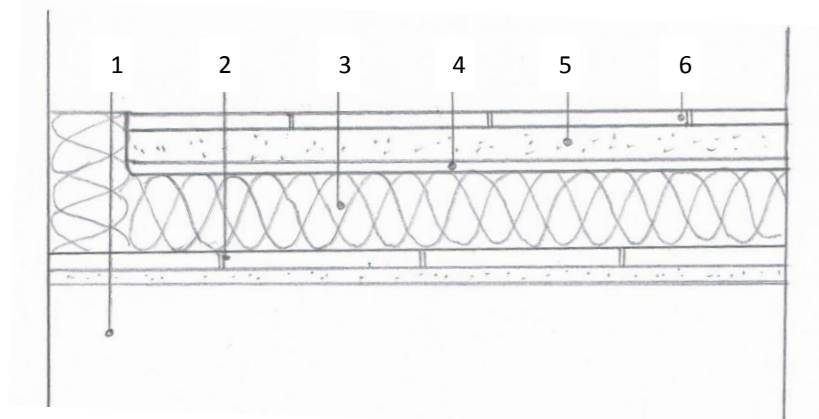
Detalle solución aislamiento suelo. Fuente: elaboración propia.
